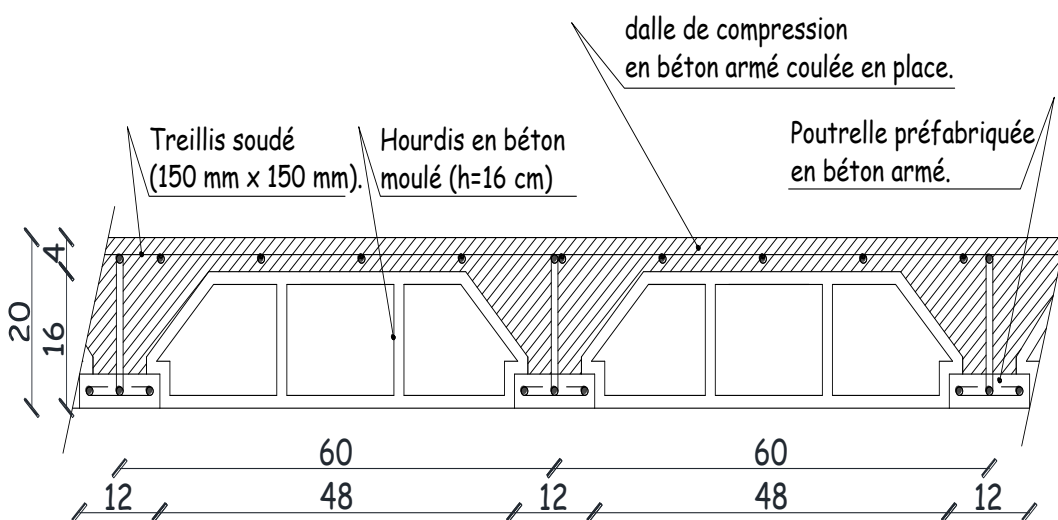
Plancher en béton armé avec poutrelles et hourdis (Plancher semi-préfabriqué)
